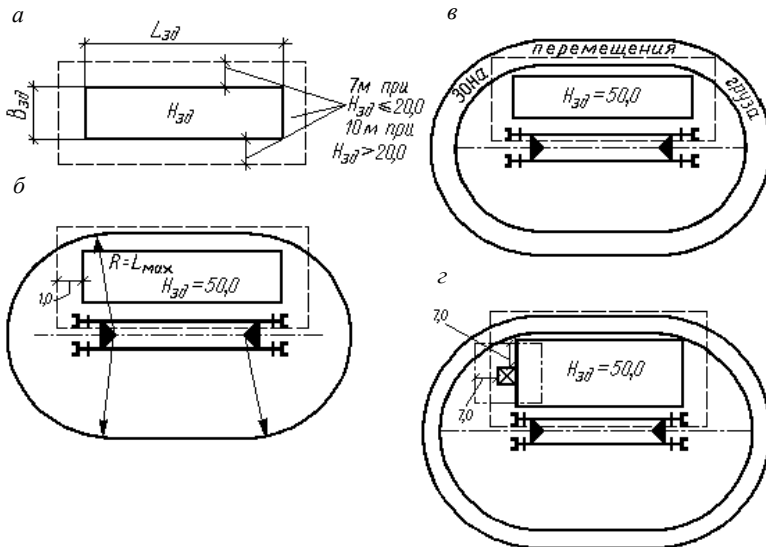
Определение необходимых зон при возведении надземной части зданий башенным или рельсовым стреловым краном:
